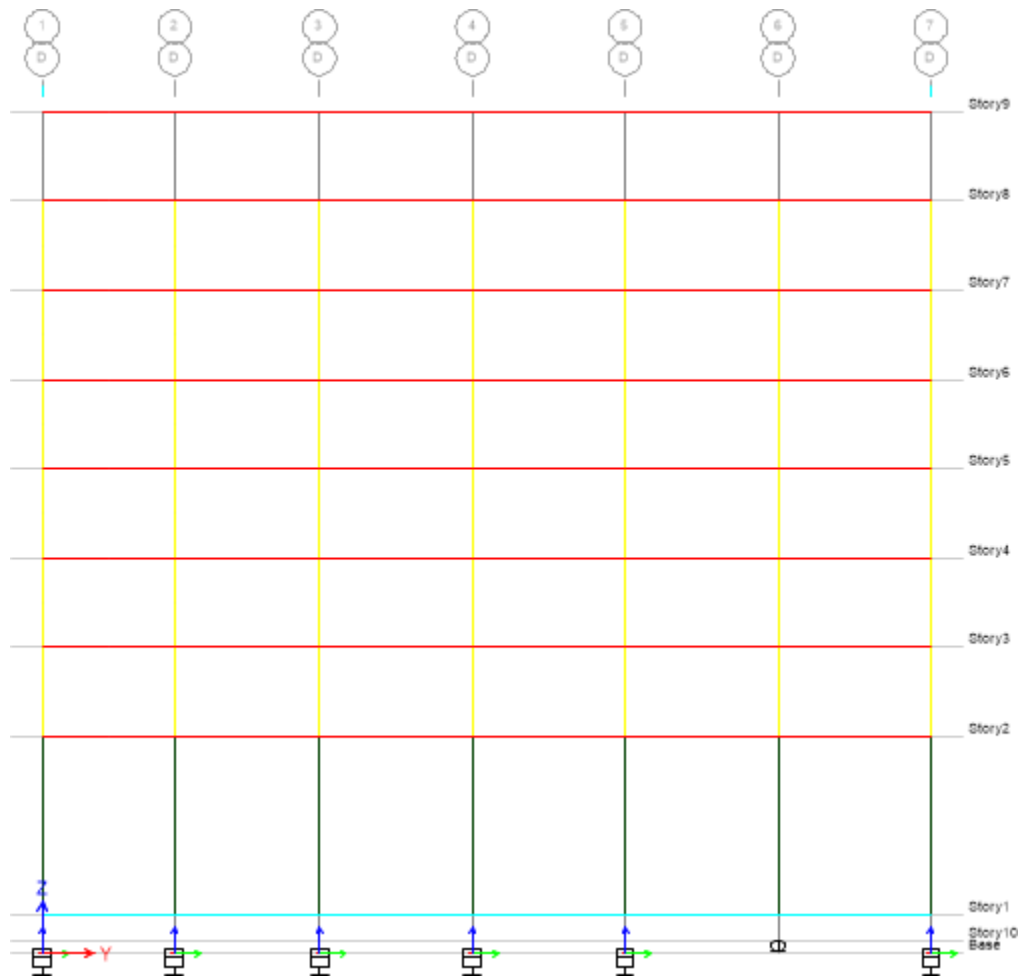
Vista en Elevación de la Estructura B con sistema de aislación
